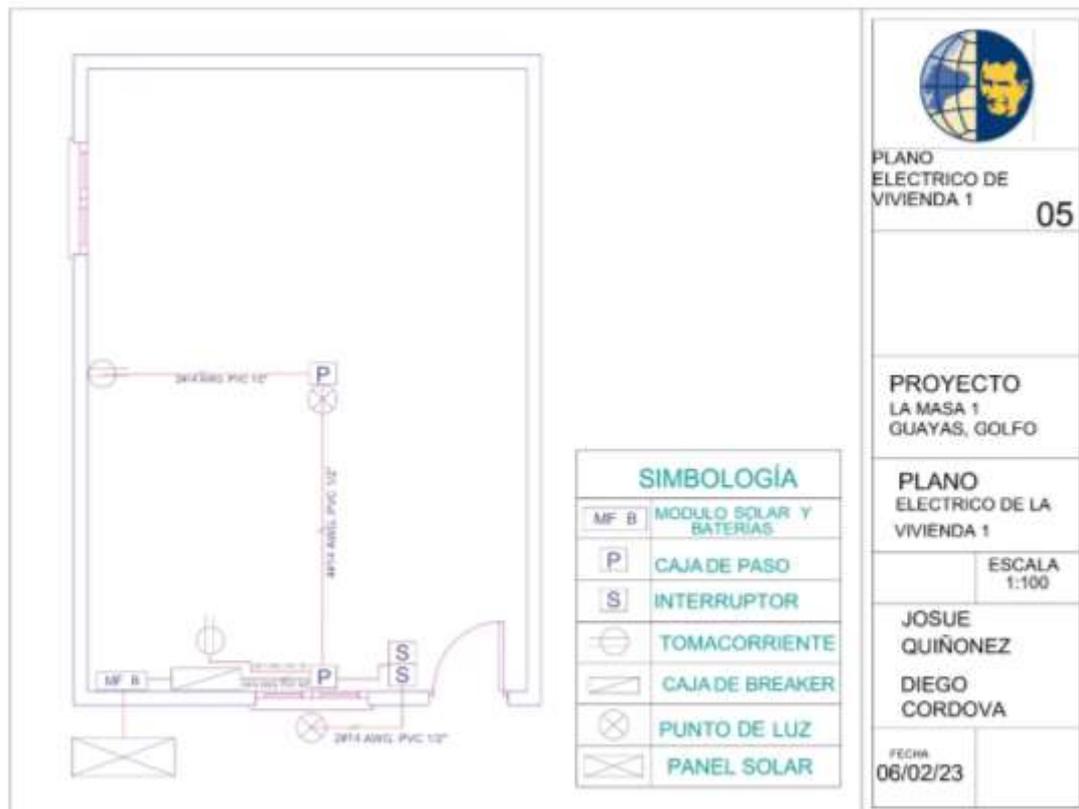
Plano eléctrico de la vivienda en AutoCAD. Fuente: Los autores.
